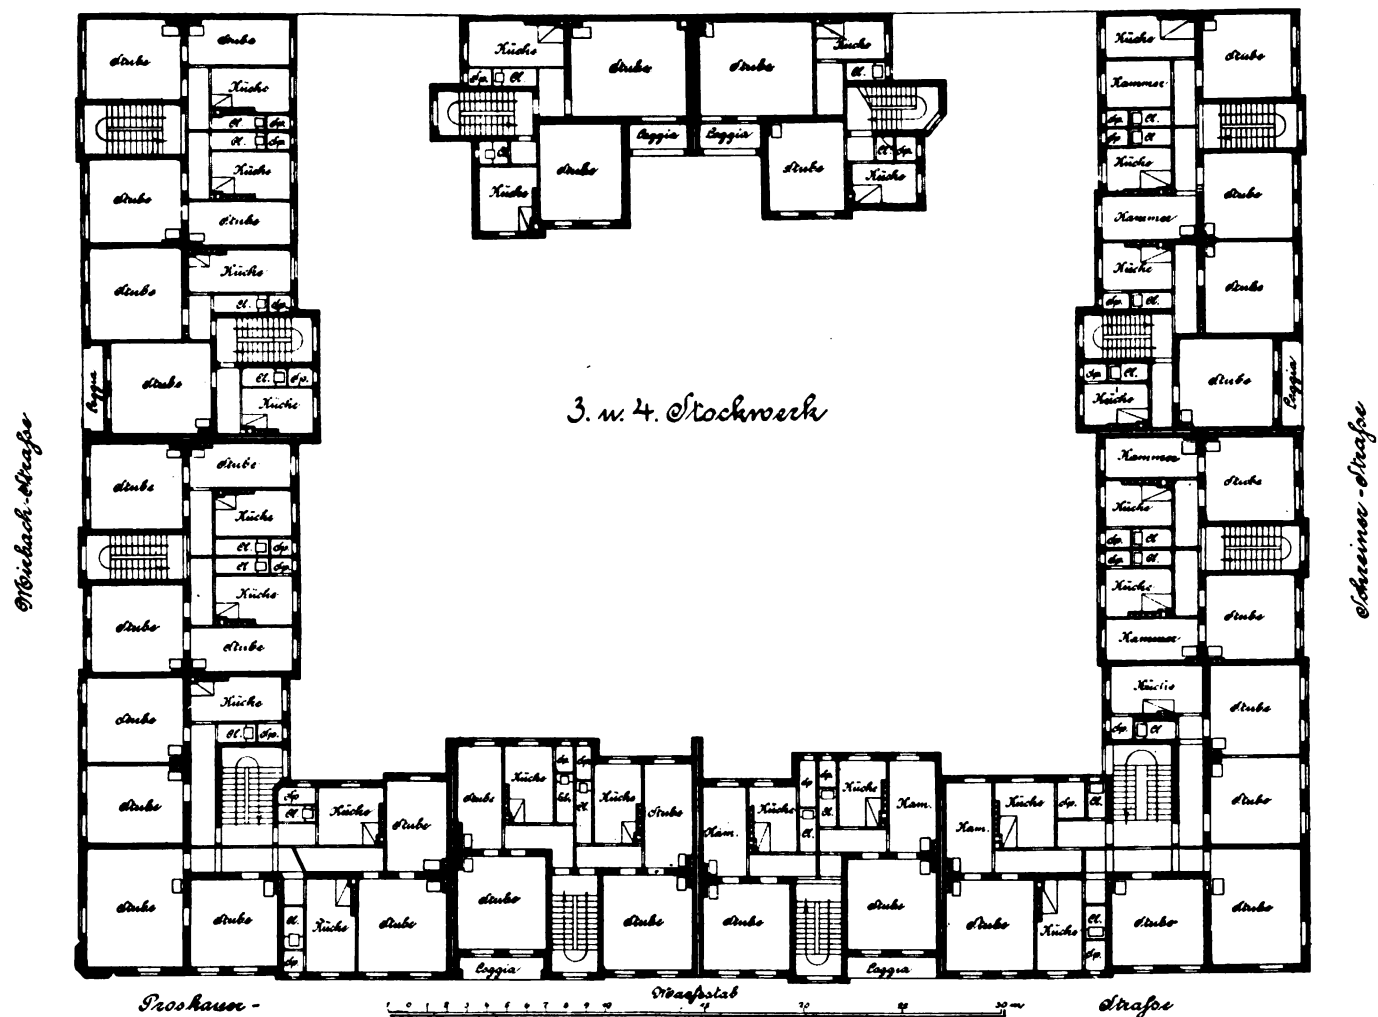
Grundriss des Hauses an der Proskauerstrasse. (3. und 4. Stockwerk.)
